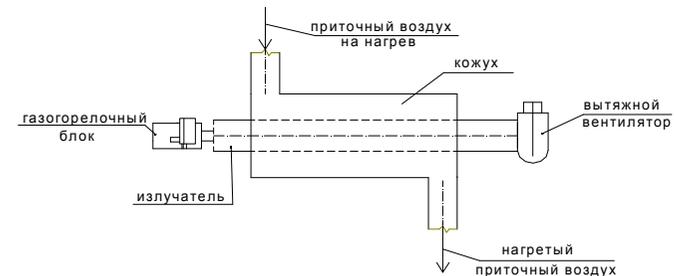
Типичное комбинированное устройство лучистого нагревателя и подогревателя приточного воздуха.
